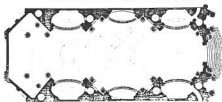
Planta de Sta. María Ettinga (Guarini).
